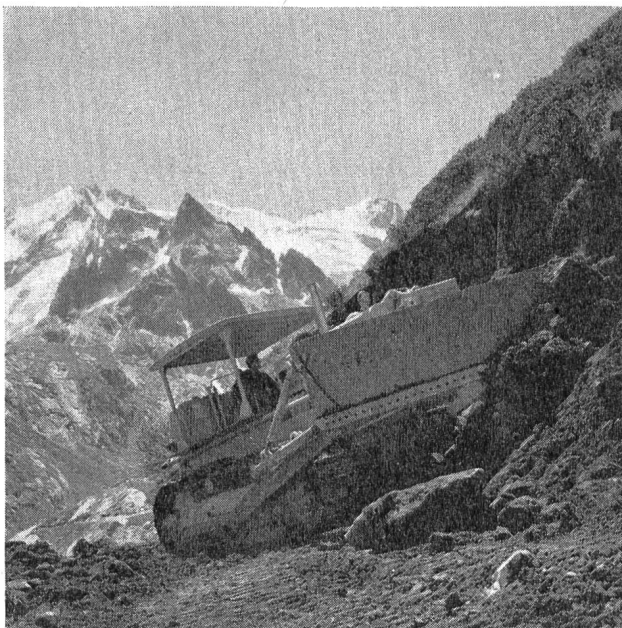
Straßenbau auf der Baustelle Albigna (Photo Beyeler, Zürich)
